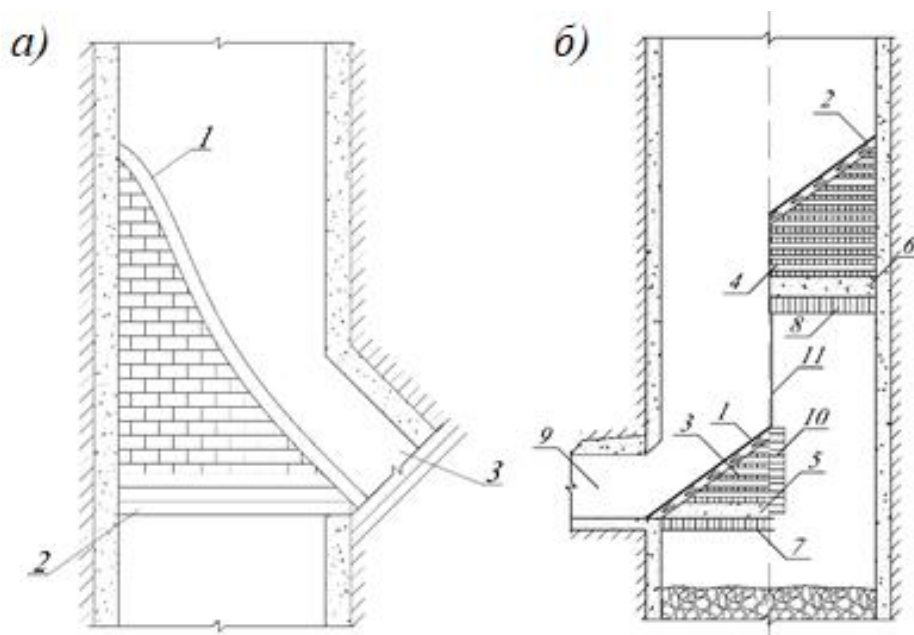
Конструкции клиновых ПП: а – Клиновой ПП конструкции С.А. Федорова:
